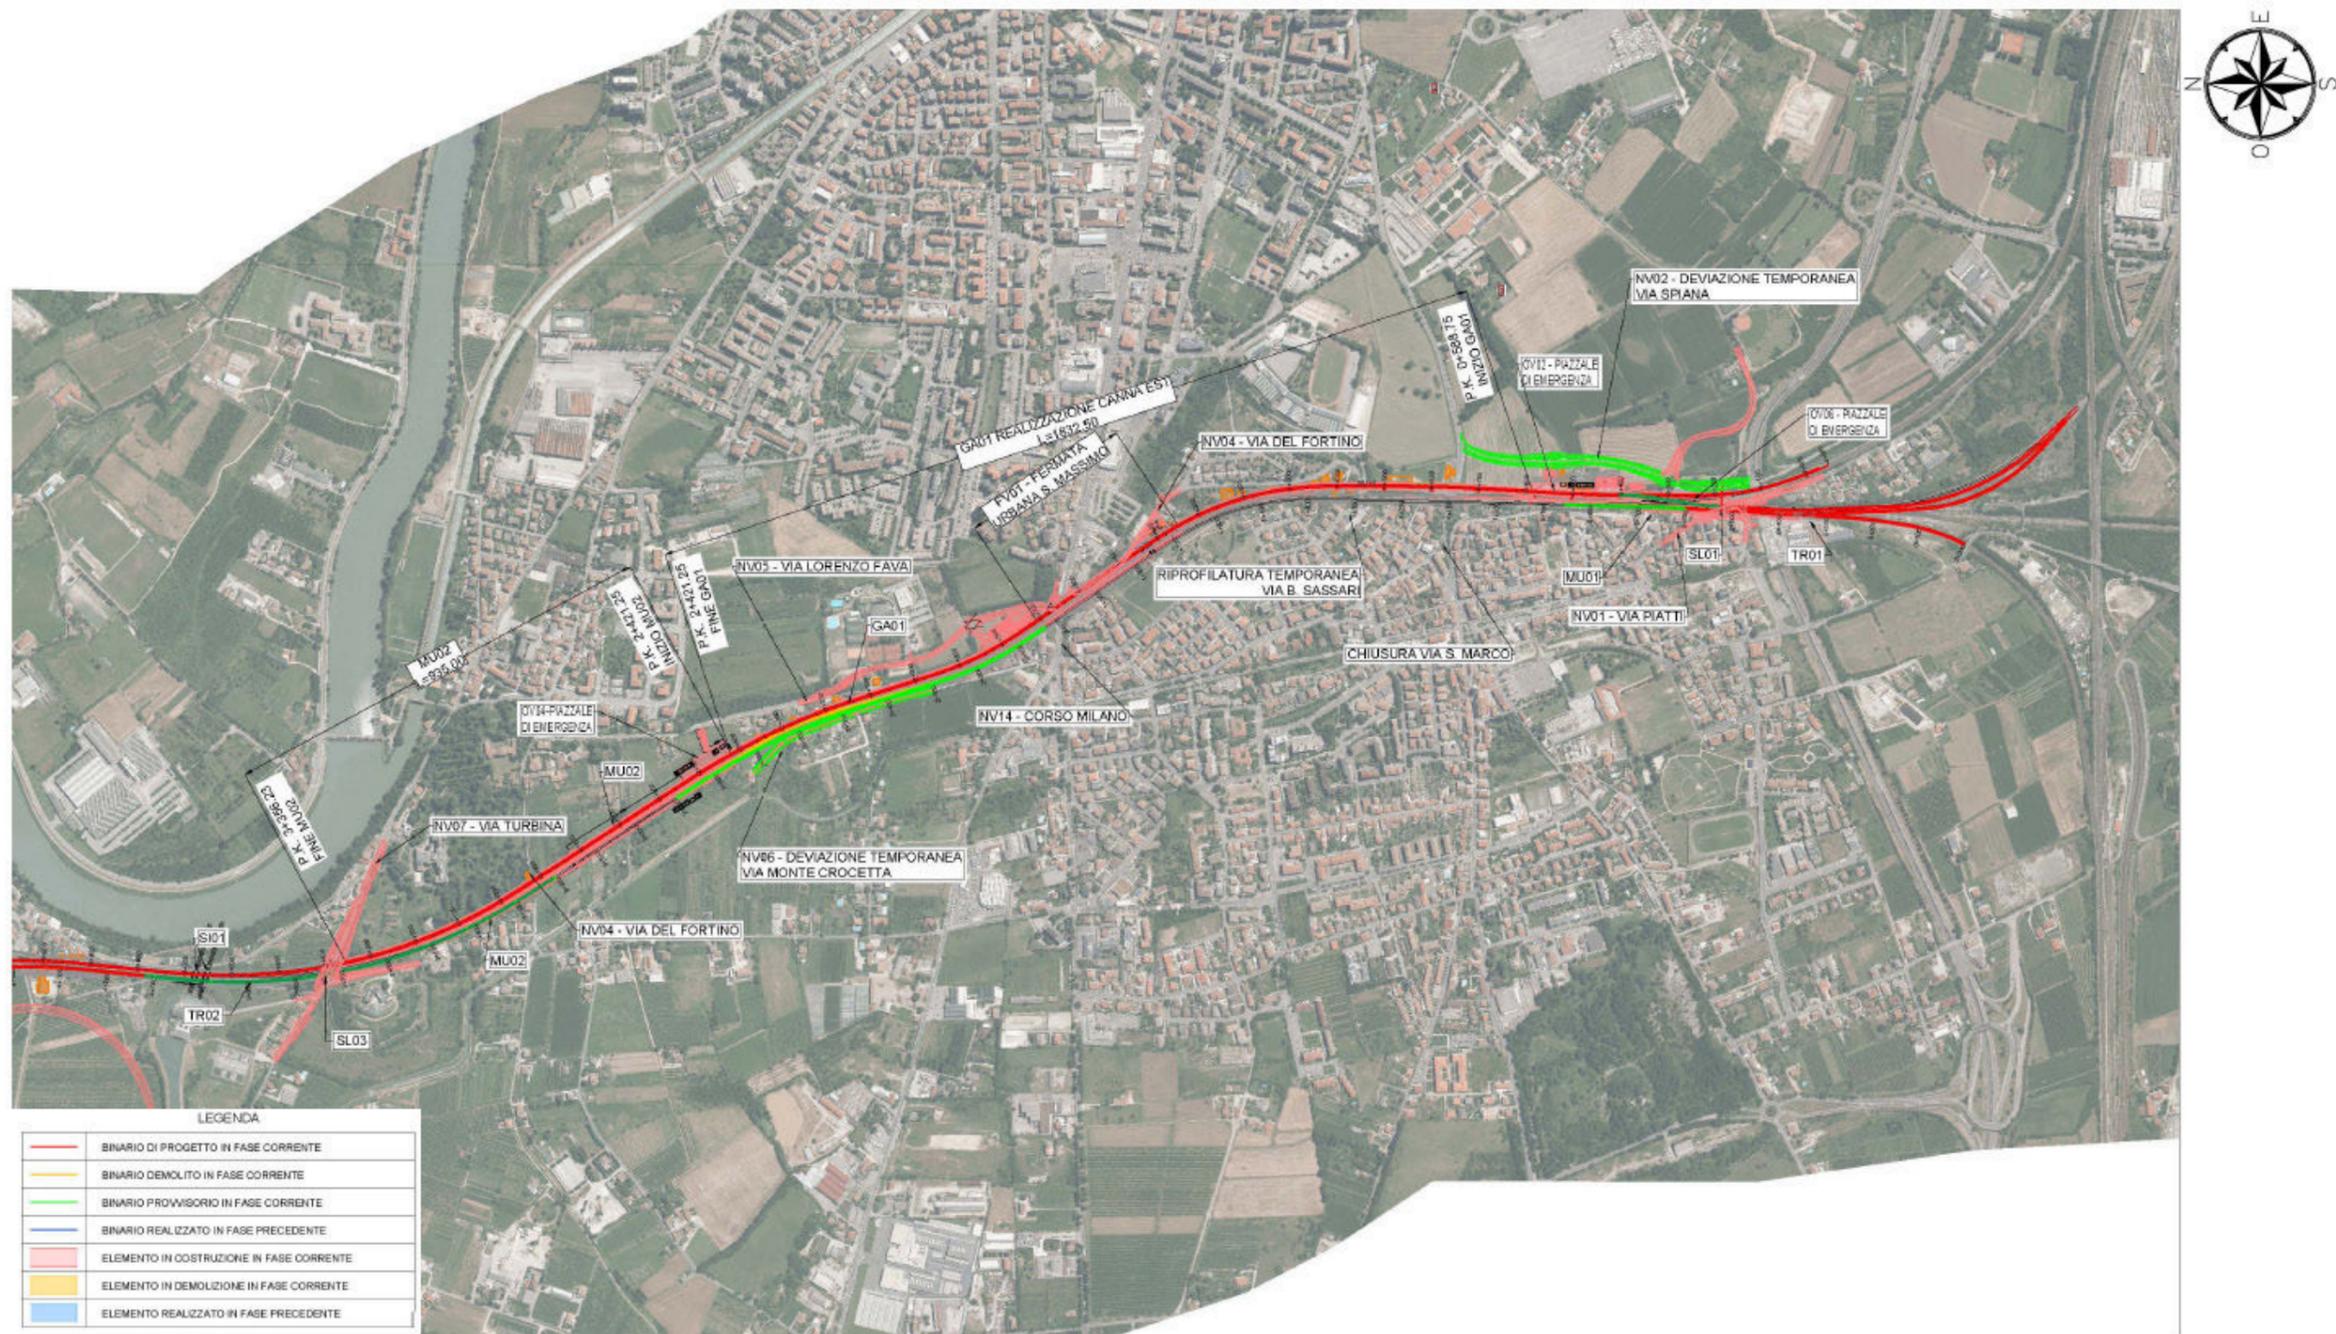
Planimetria su ortofoto Macrofase I - Tav. 2/2
